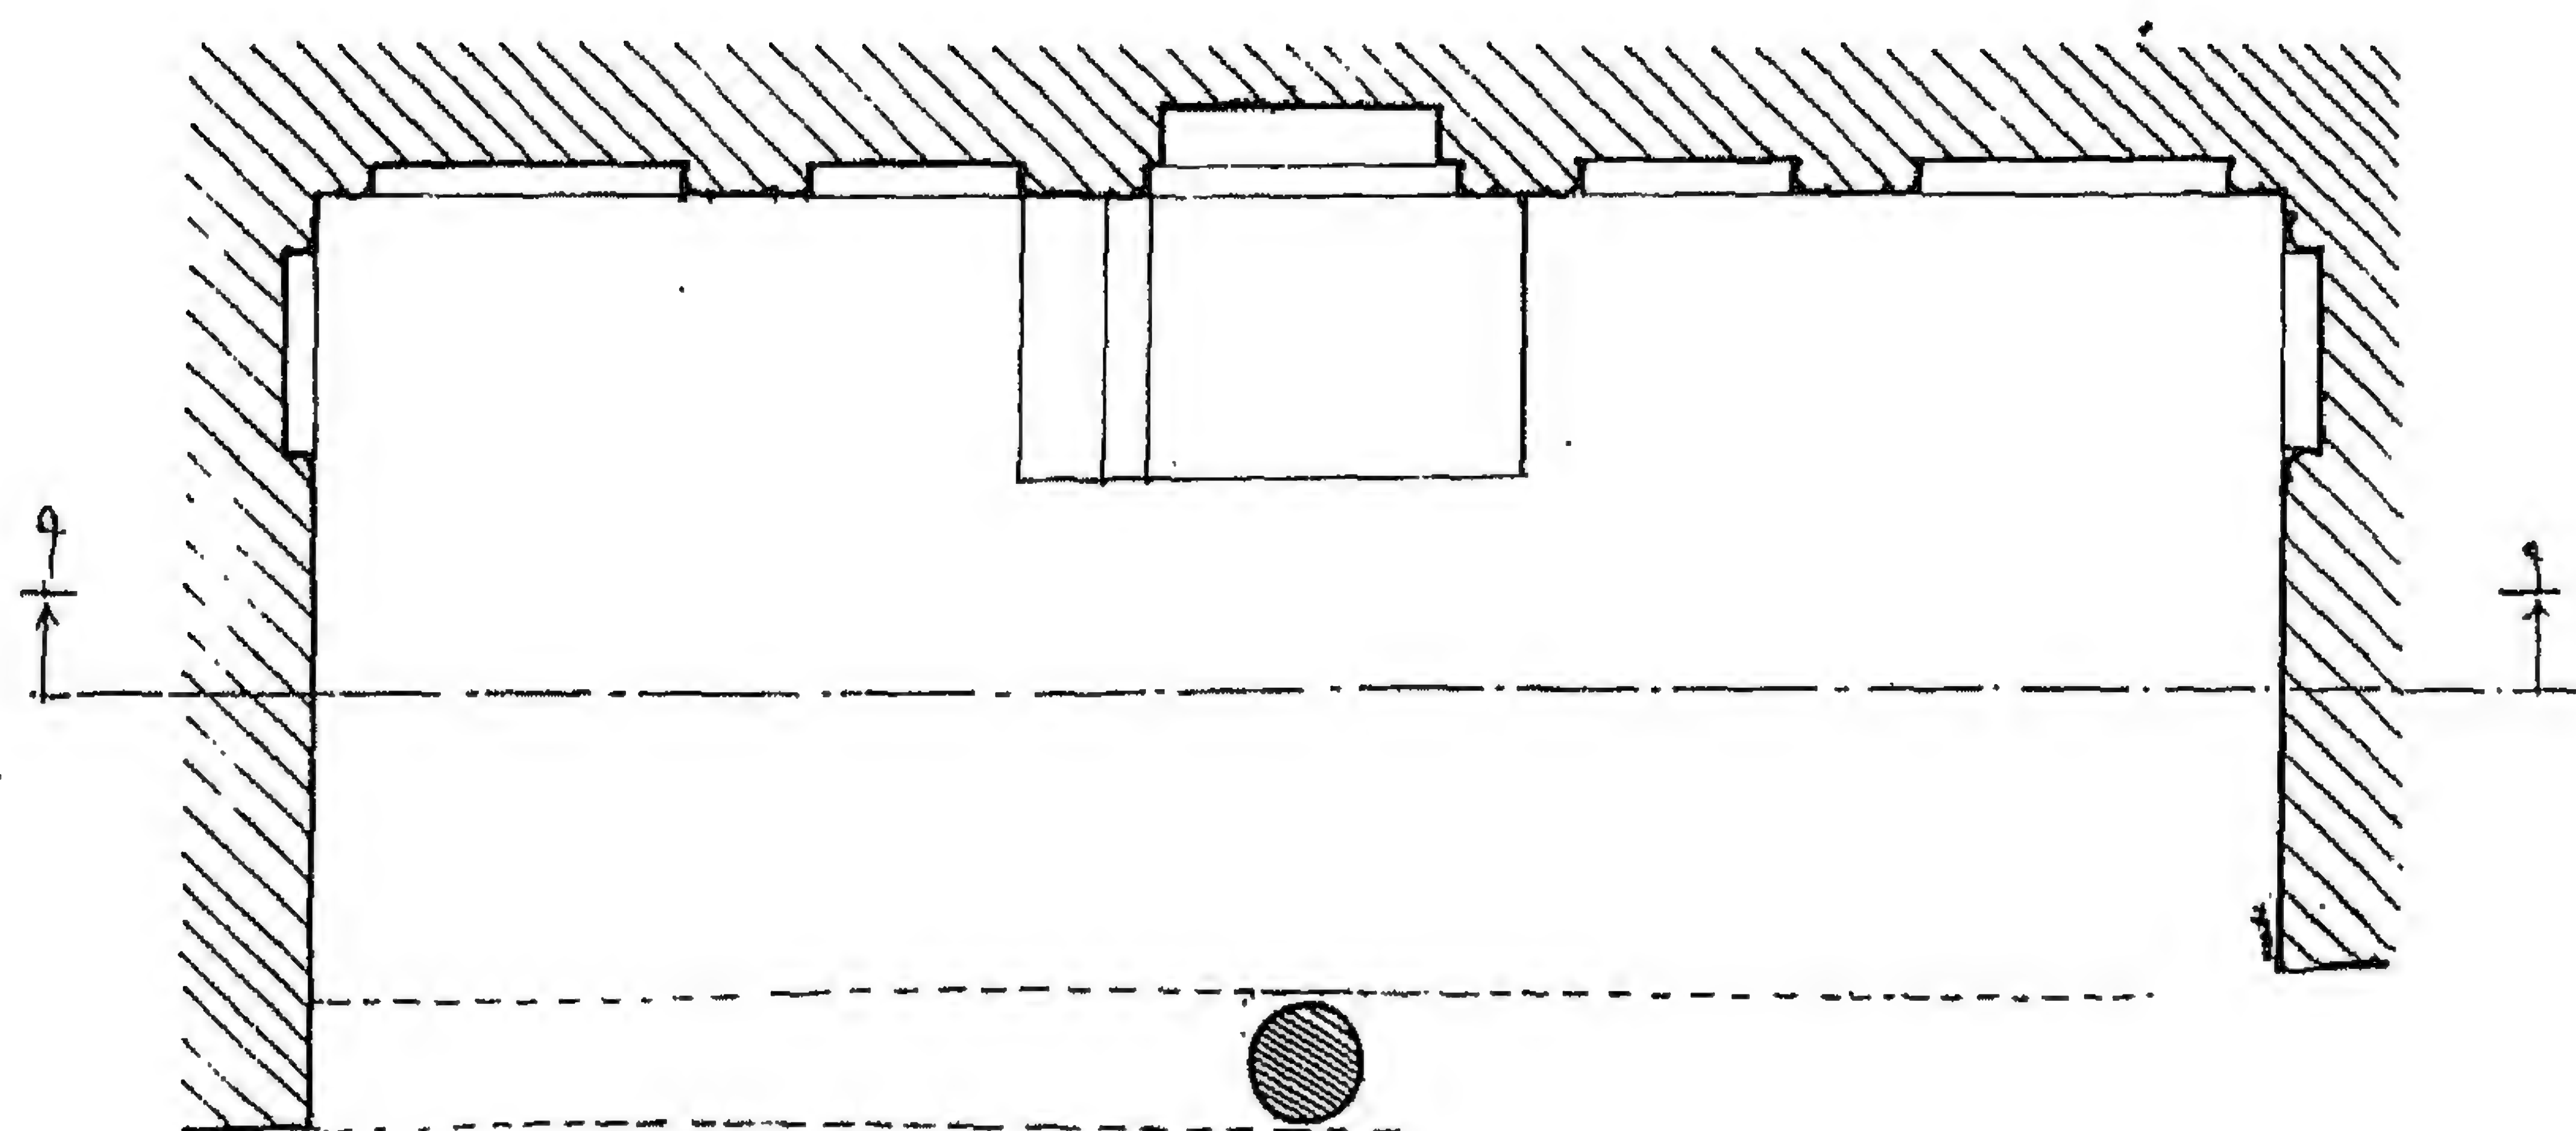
مسقط أفقي لحوض إبراهيم أغا
